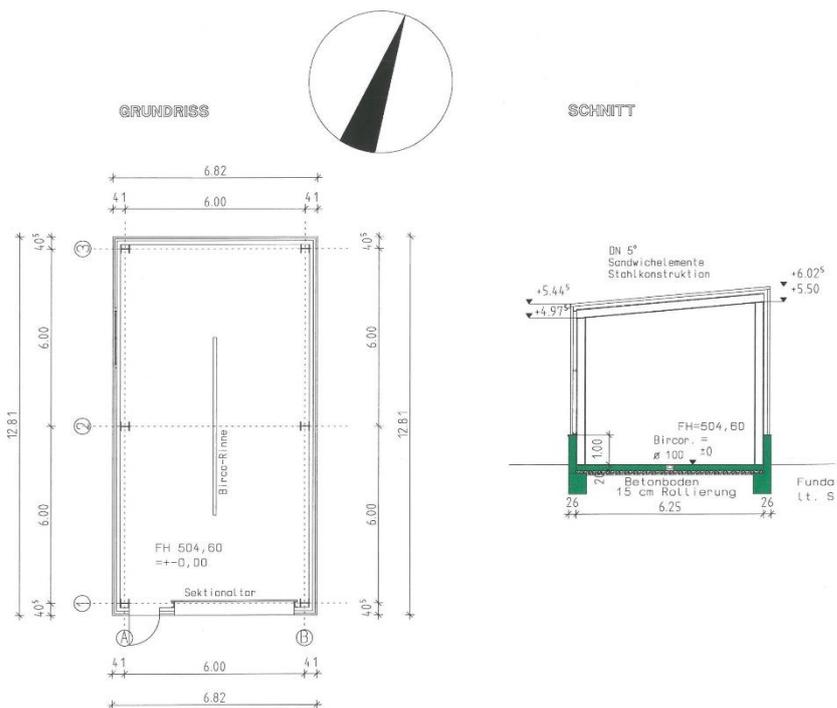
Grundriss und Abmessungen der Leichtbauhalle
